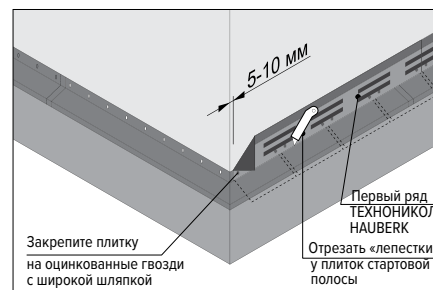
Монтаж стартовой полосы фасадной плитки
